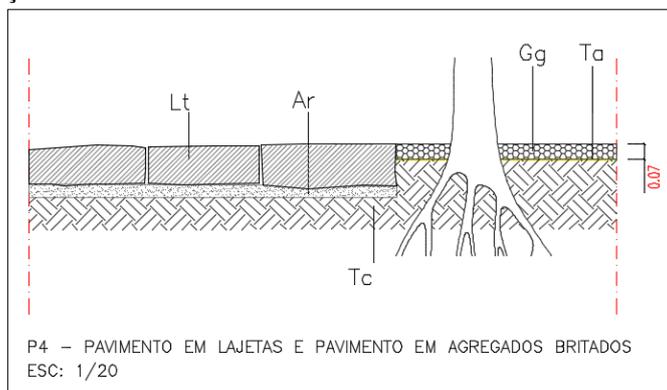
Pormenor de Construção do Projeto de espaços exteriores da Quinta Alegre, Lisboa
